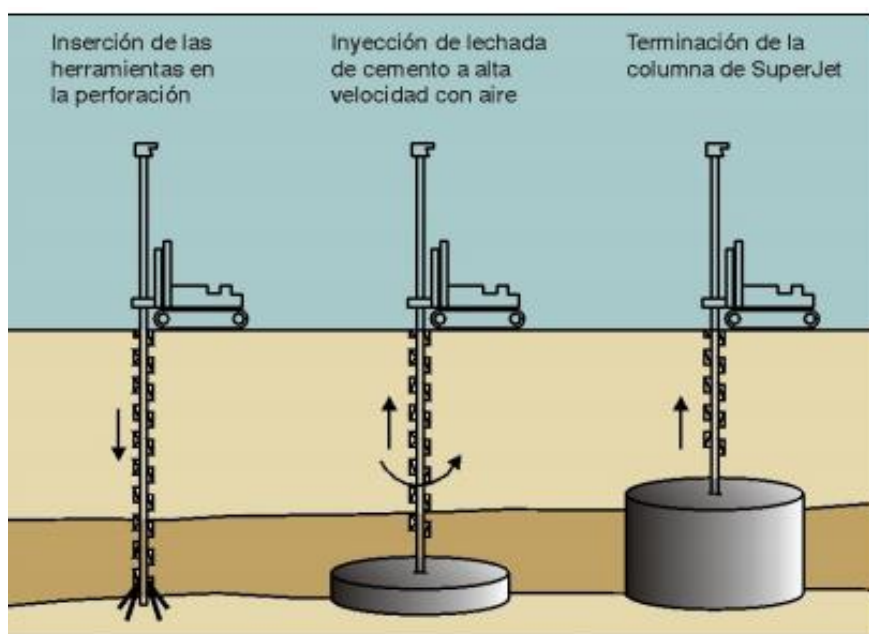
proceso de ejecución super Jet-Grouting, fuente Jet_GROUTING_Juan_Manuel_Fernandez.pdf
